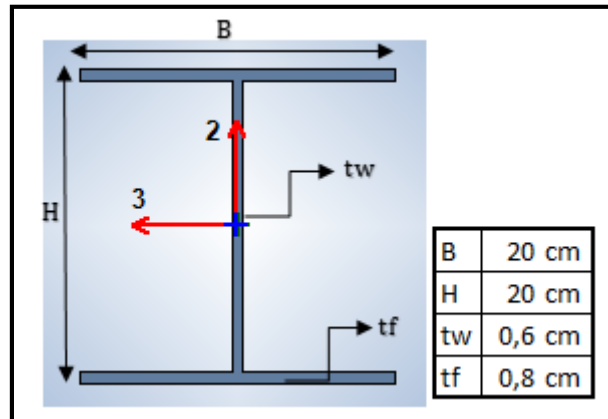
Dimensiones, Columna 3 con pórticos arriostrados.
